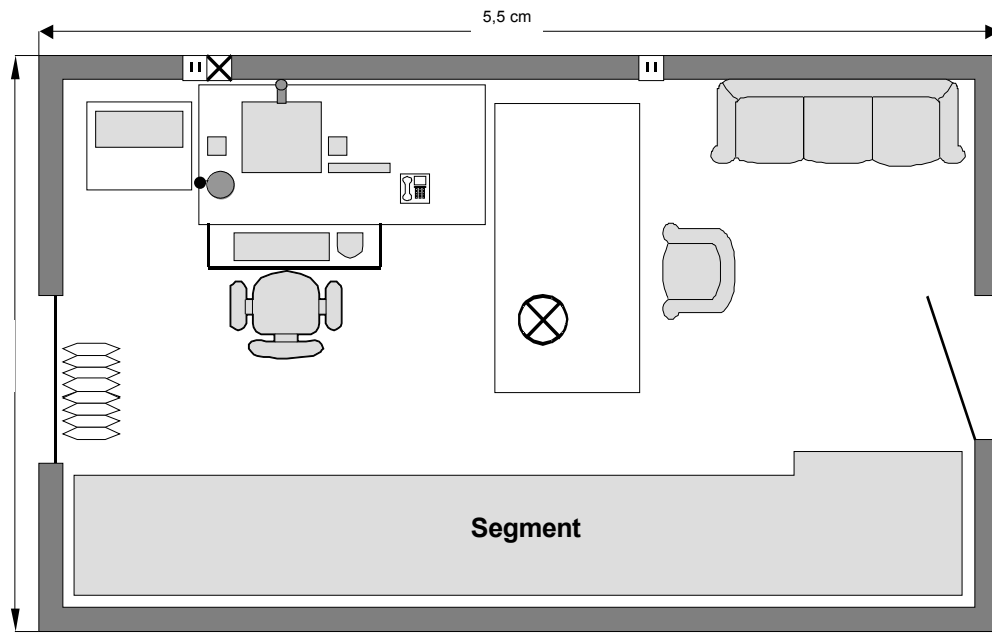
Przykładowy plan rozmieszczenia elementów w przestrzeni roboczej .
